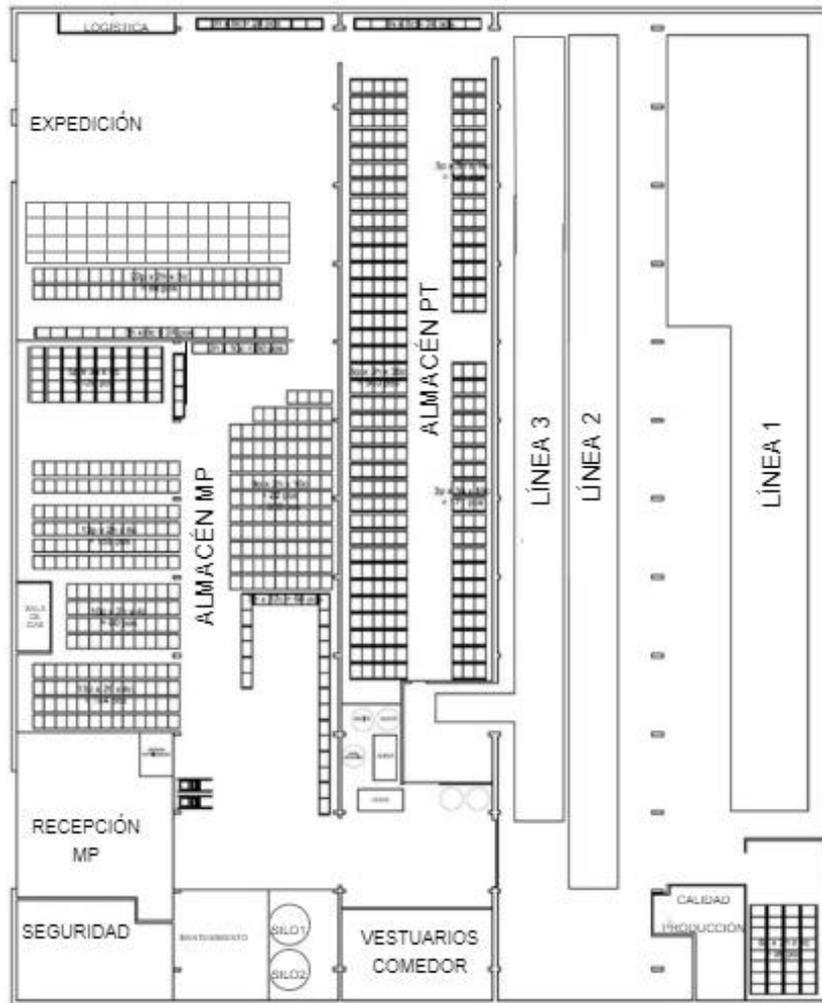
Layout de la planta. Fuente: Elaboración propia.
